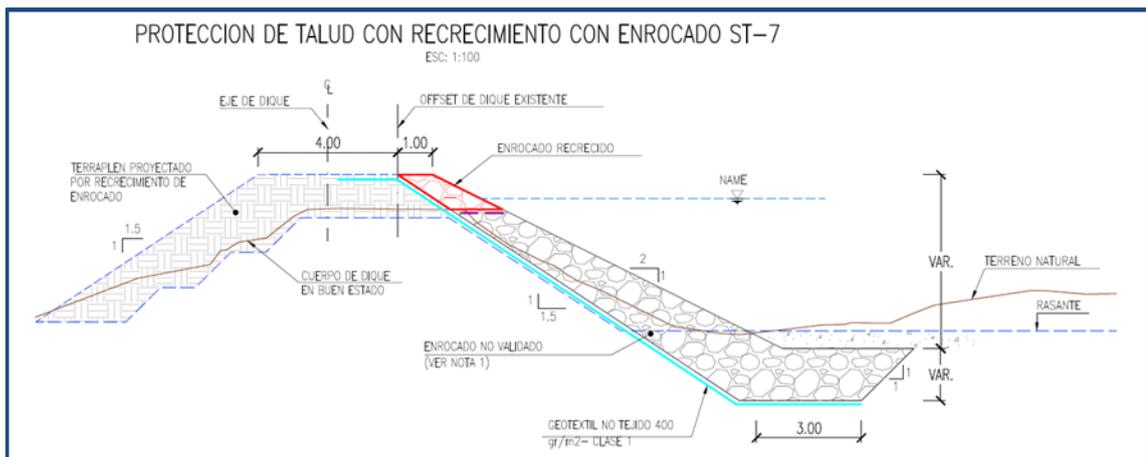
Protección de talud con recrecimiento con enrocado ST-7
